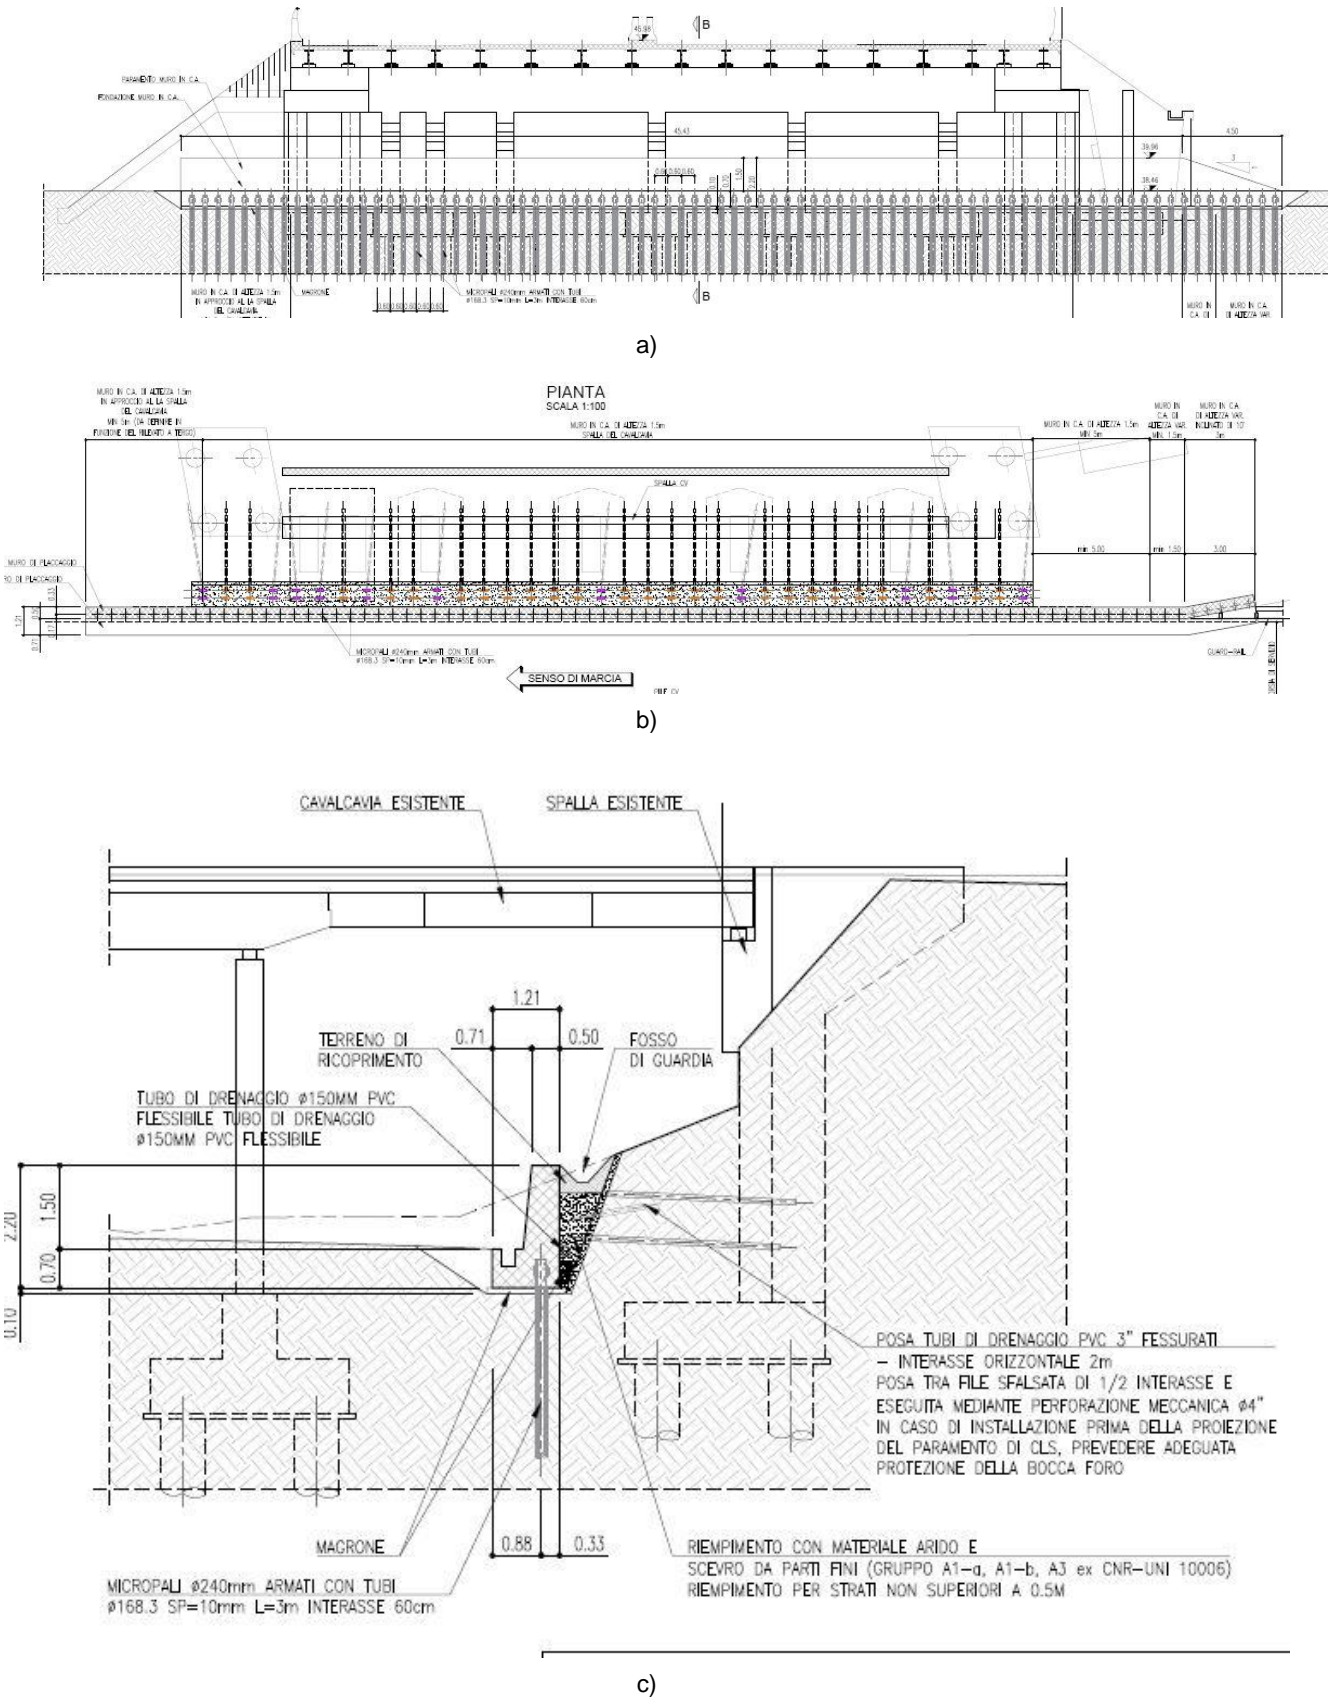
Intervento CV004: profilo longitudinale a); stralcio planimetrico b); sezione tipo in corrispondenza muro di sostegno c).
